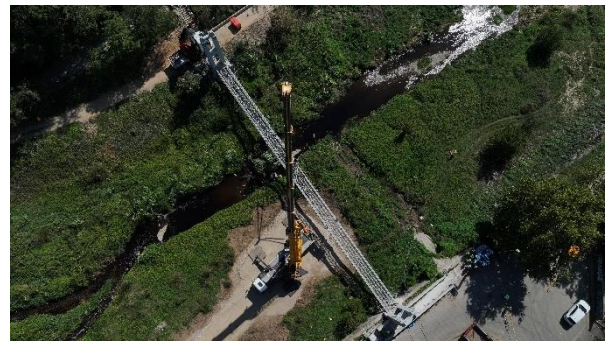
Montaje de la pasarela del Molí d'en Fontanet.
